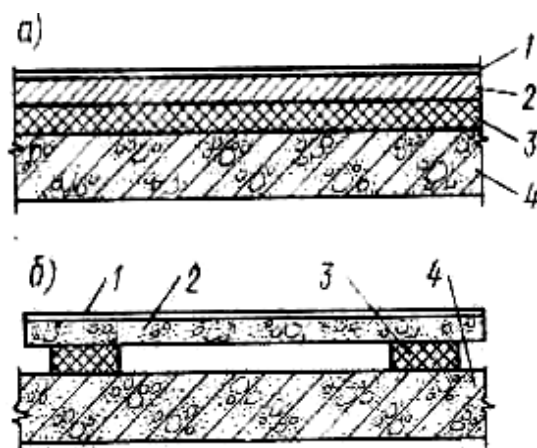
Схема применения звукоизоляционных материалов в междуэтажных перекрытиях:
